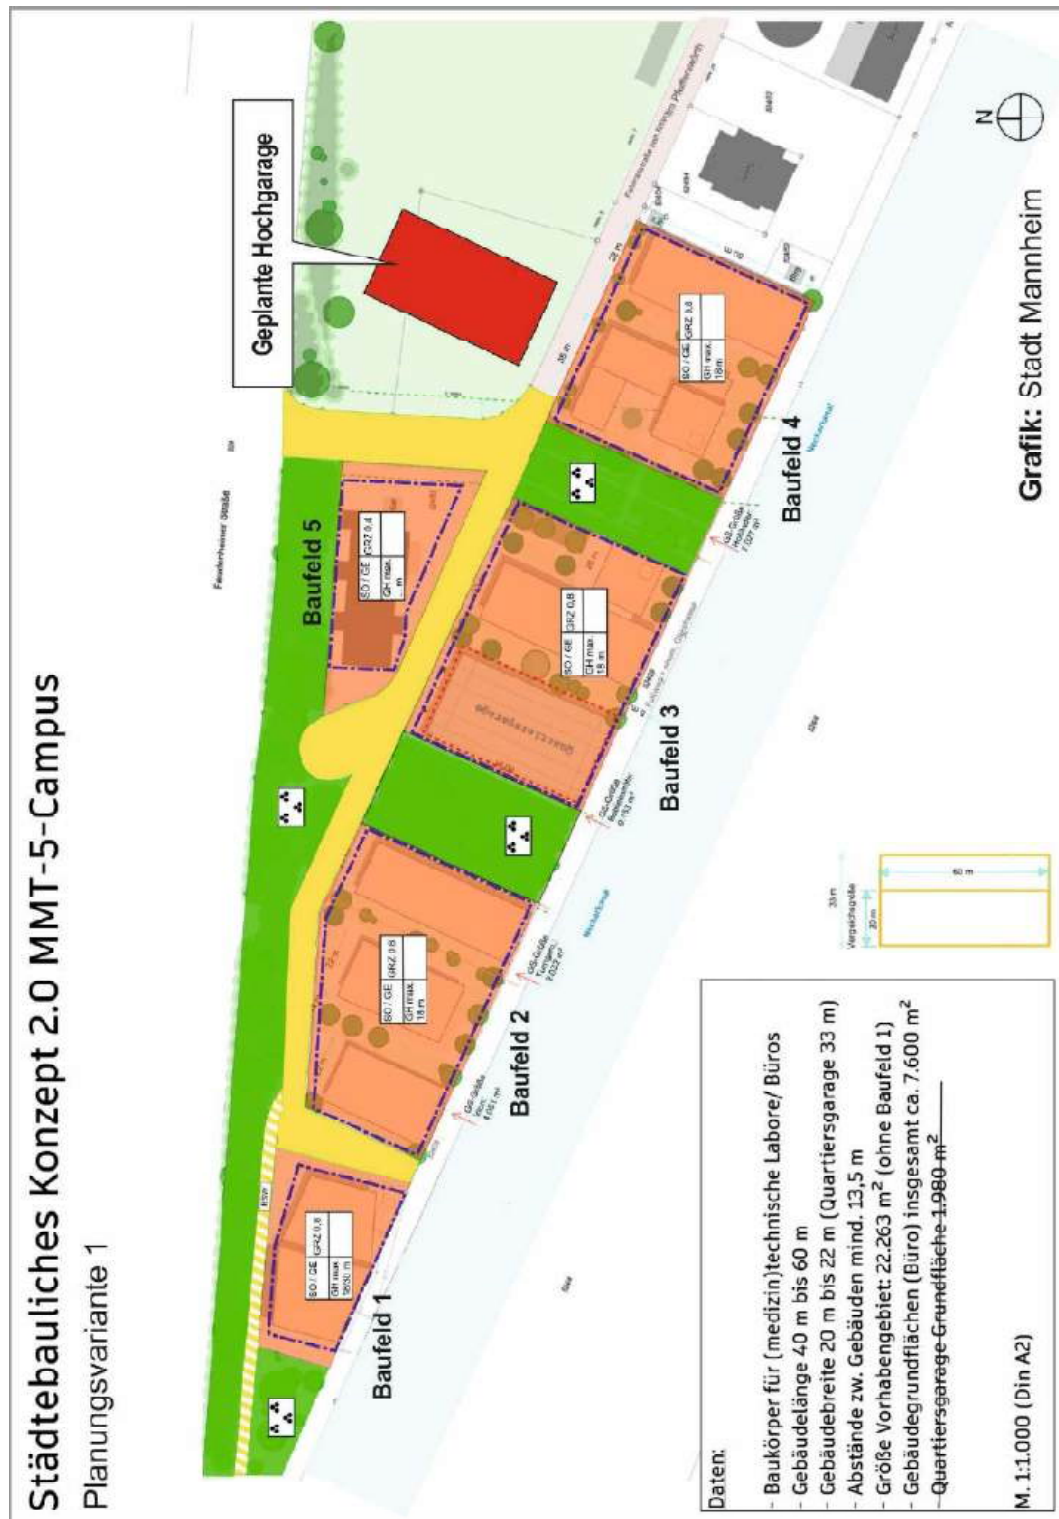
Städtebauliches Konzept „MMT-5 Campus“ - Planungsvariante 1
